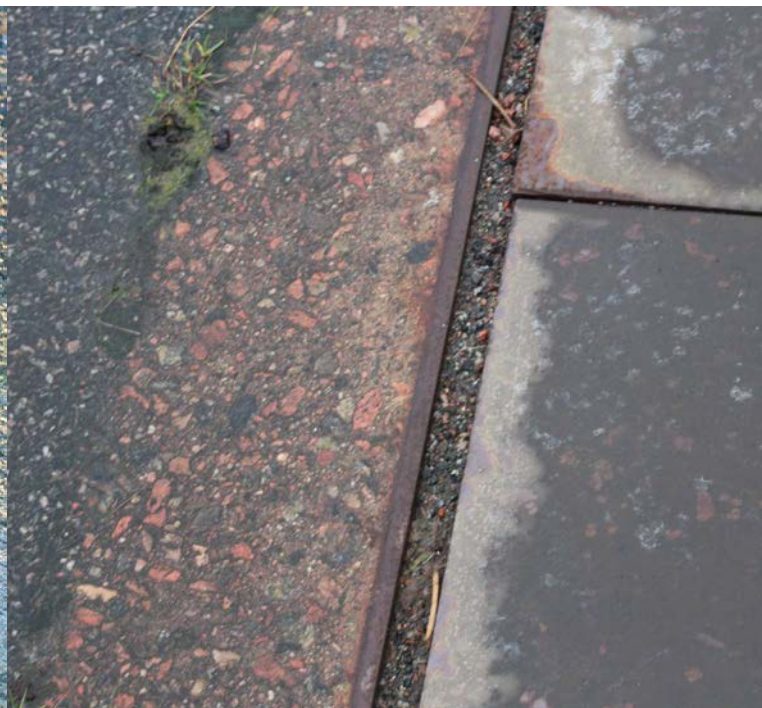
Ovan syns ett strukturerat materialmöte mellan betongplattor, järnkant och asfalt.
